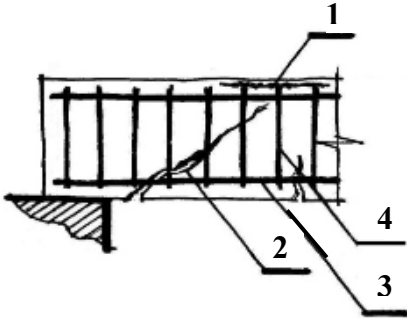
Схема руйнування залізобетонного елемента по похилому січенню через просмикування арматури на вільній опорі: 1 – поздовжні тріщини в стиснутій зоні елемента; 2 – похила тріщина; 3 – поздовжня розтягнута арматура; 4 – поперечна арматура
